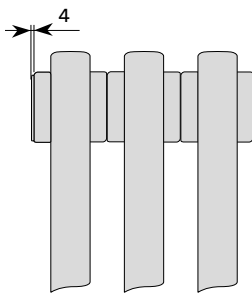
Längenzuschlag für geschweißte Deckel; der Längenzuschlag ist für beide Seiten des Heizkörpers zu berücksichtigen
